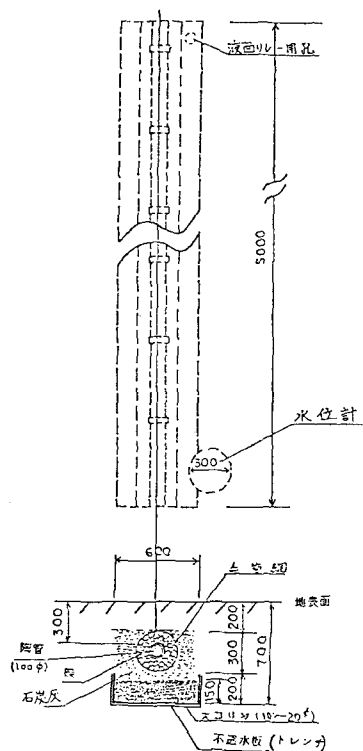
地下埋管・トレンチ断面図 (単位: mm)
